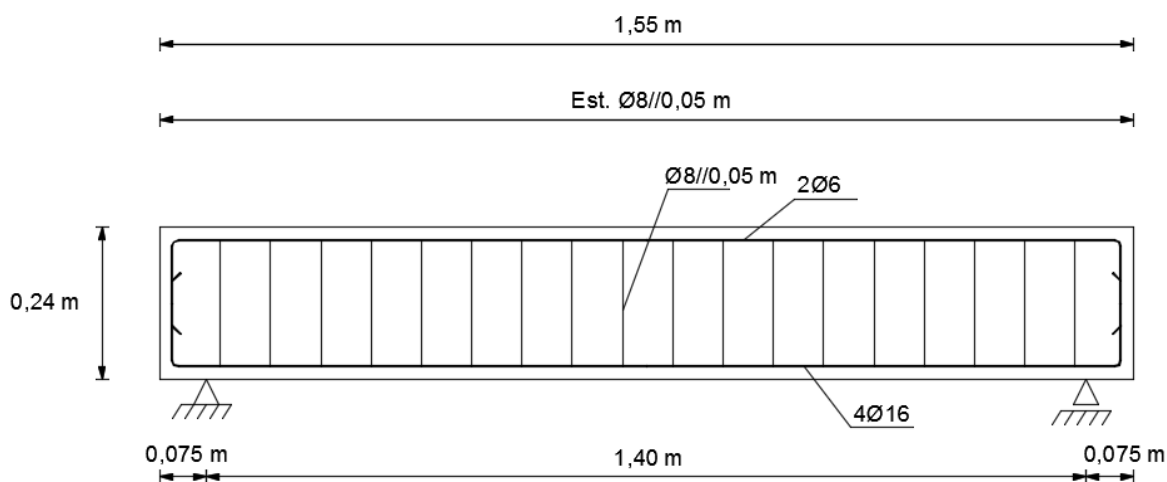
Corte longitudinal de viga-tipo - ensaio à flexão
